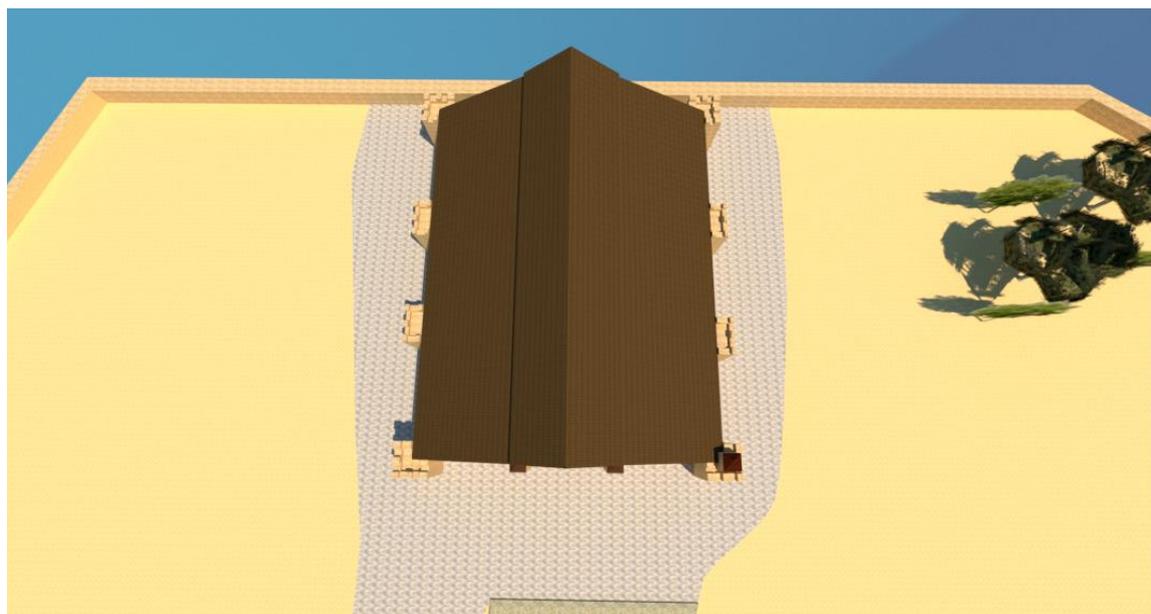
Vista en planta del Alhorí. Imagen renderizada
